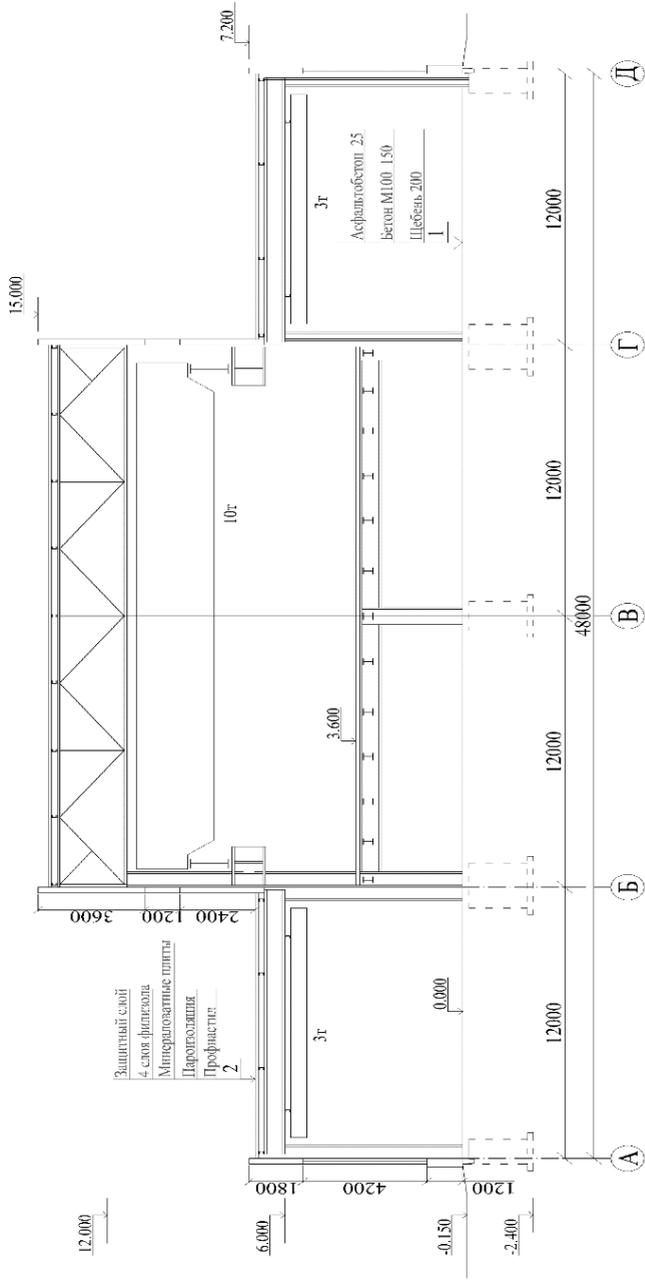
Пример поперечного разреза производственного здания с металлическим каркасом и «нулевой» привязкой колонн к продольным осям.
